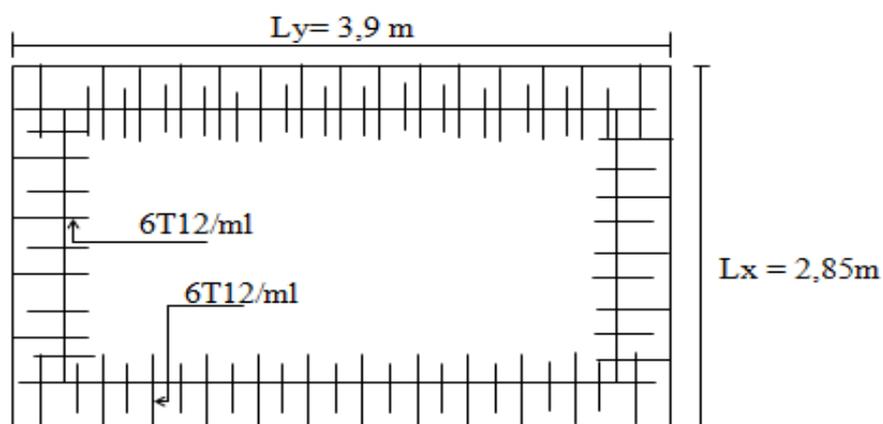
Dessin Ferrailage Supérieur du panneau de la dalle pleine.
